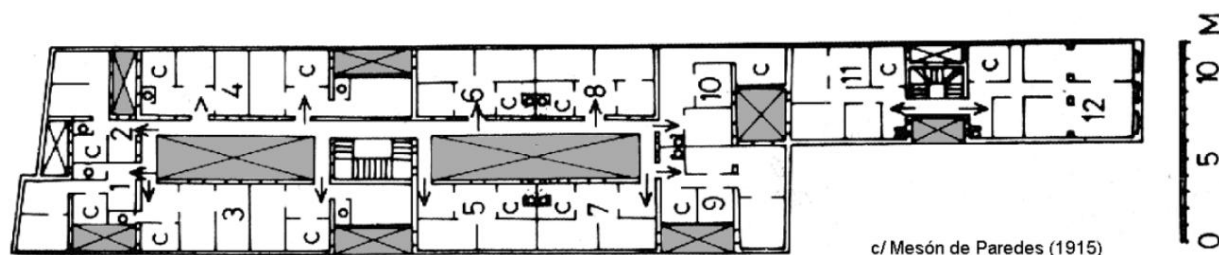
Edificio en la c/ Mesón de Paredes 54 (1915), con 5.40m de frente de fachada y 57m de fondo, sobre un solar de 663m<sup>2</sup>, una ocupación del 79% y 2642m<sup>2</sup> edificados sobre rasante. De las 13 viviendas por planta (5 plantas), solo una da a la calle [23]
